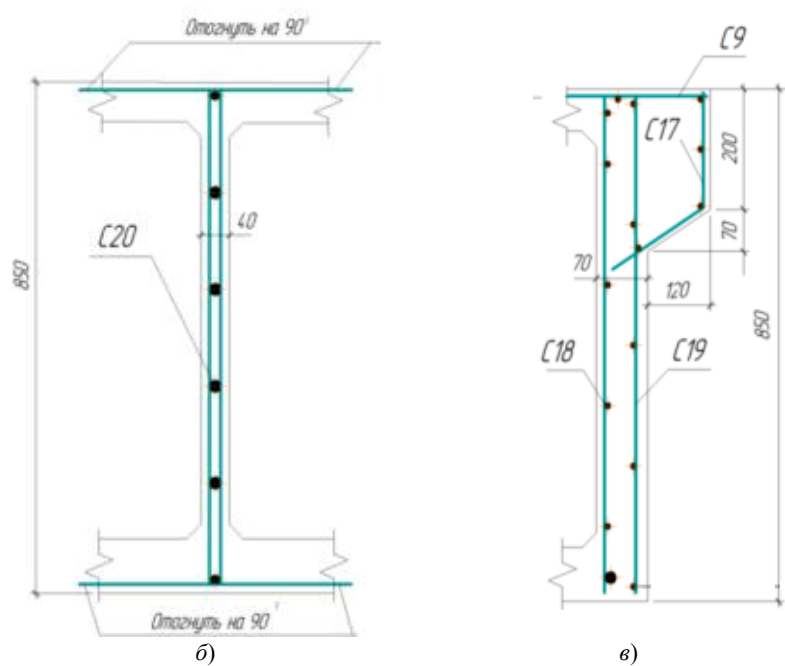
Схема армирования понтона проекта М3320BRS (тип 1):
